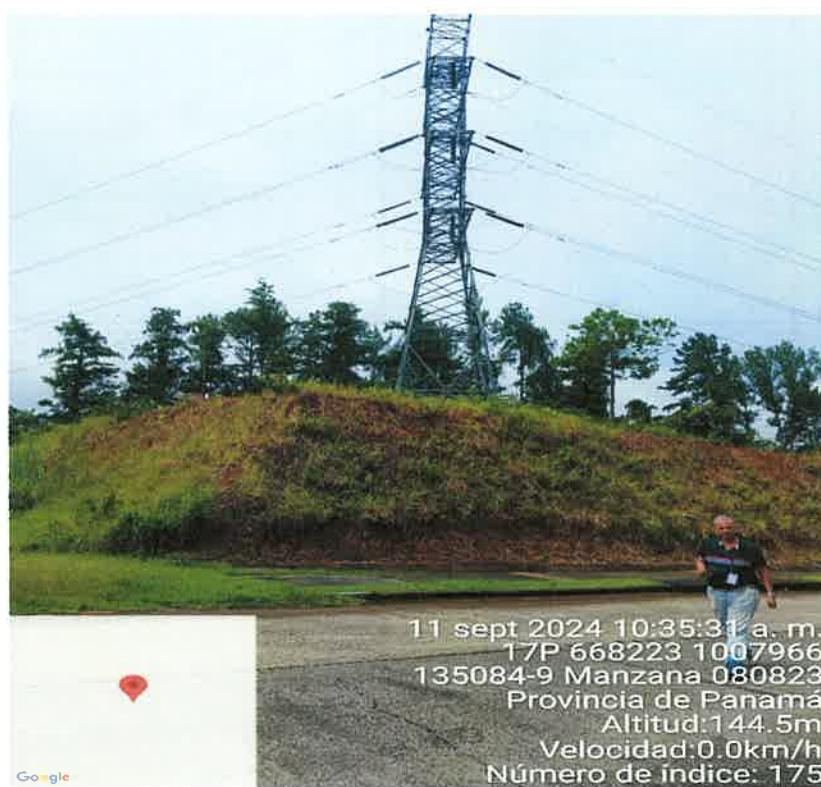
Se puede apreciar una torre de tendido eléctrico ubicada a aproximadamente 10 metros del sitio donde se pretende construir el puente.
